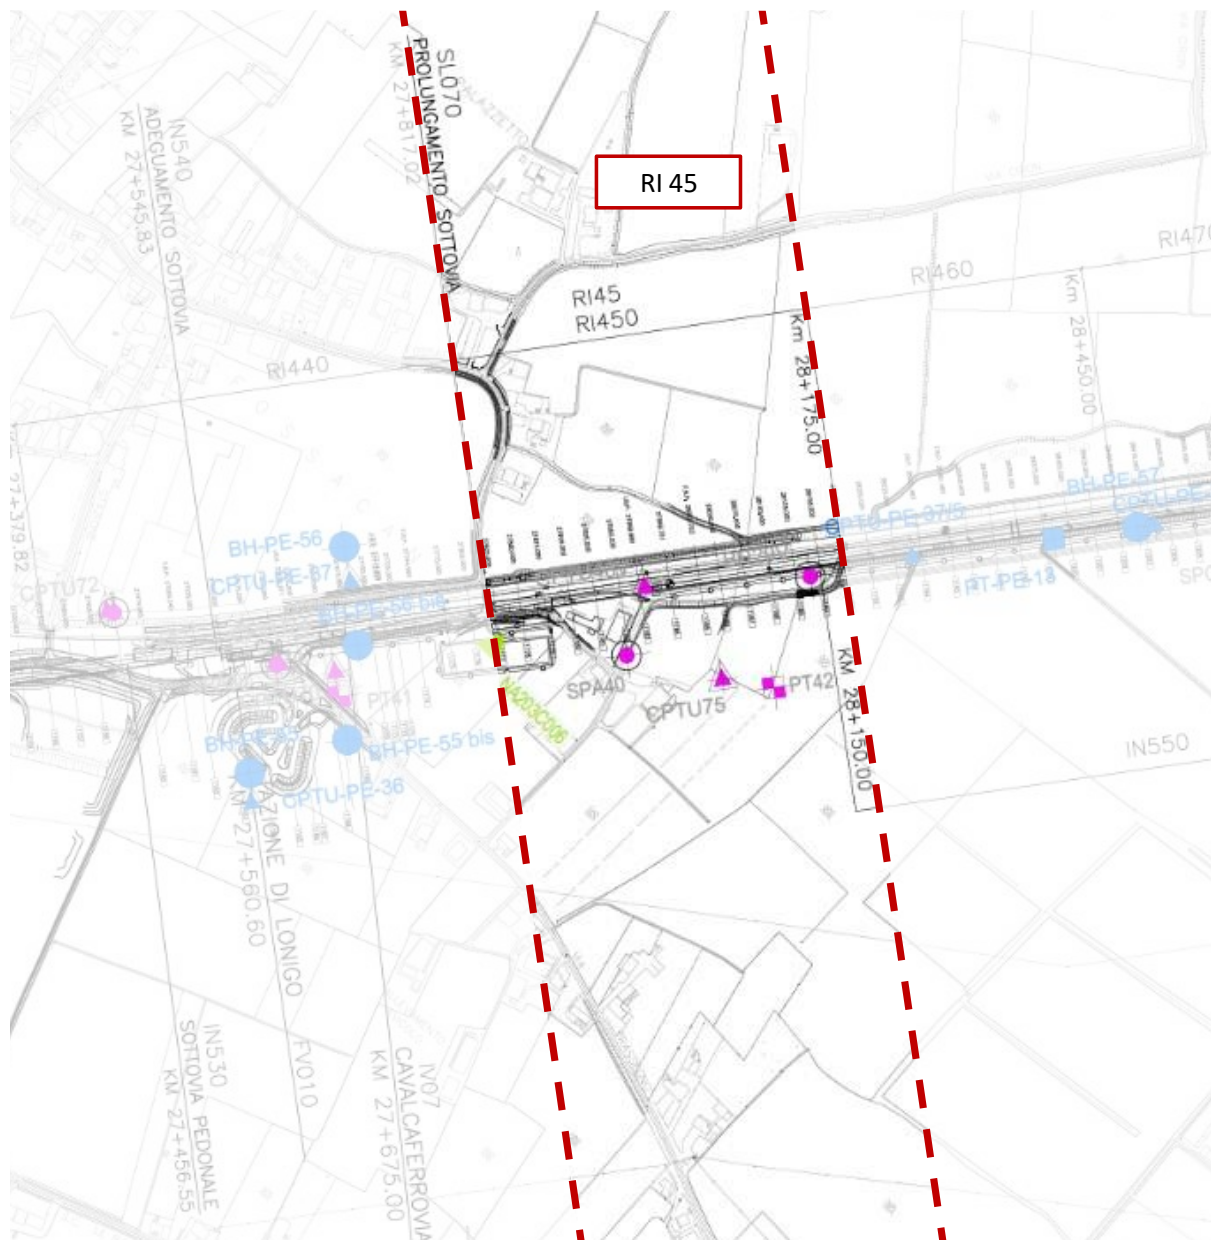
Planimetria Rilevato RI45, estratto dalla Planimetria Generale (Doc. Rif. [3])
